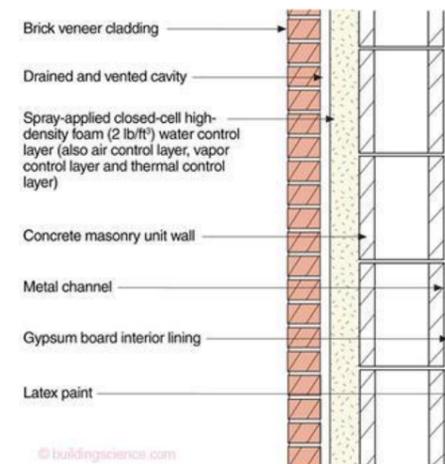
Muro comercial tipo I. Fuente: Building science. Elaboración: Building science. (2020).
